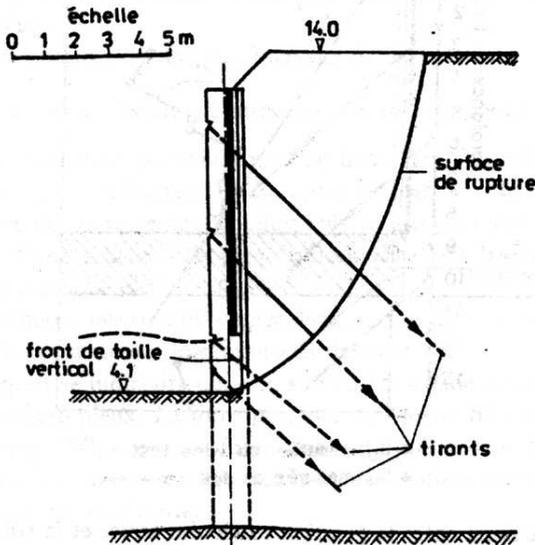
Coupe de mur berlinois et allure de la surface de rupture
